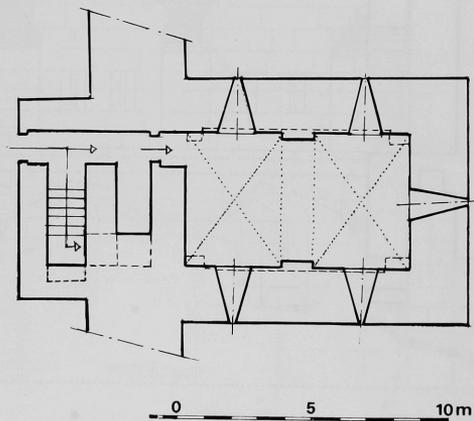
Bastion 10, plan du rez-de-chaussée.
